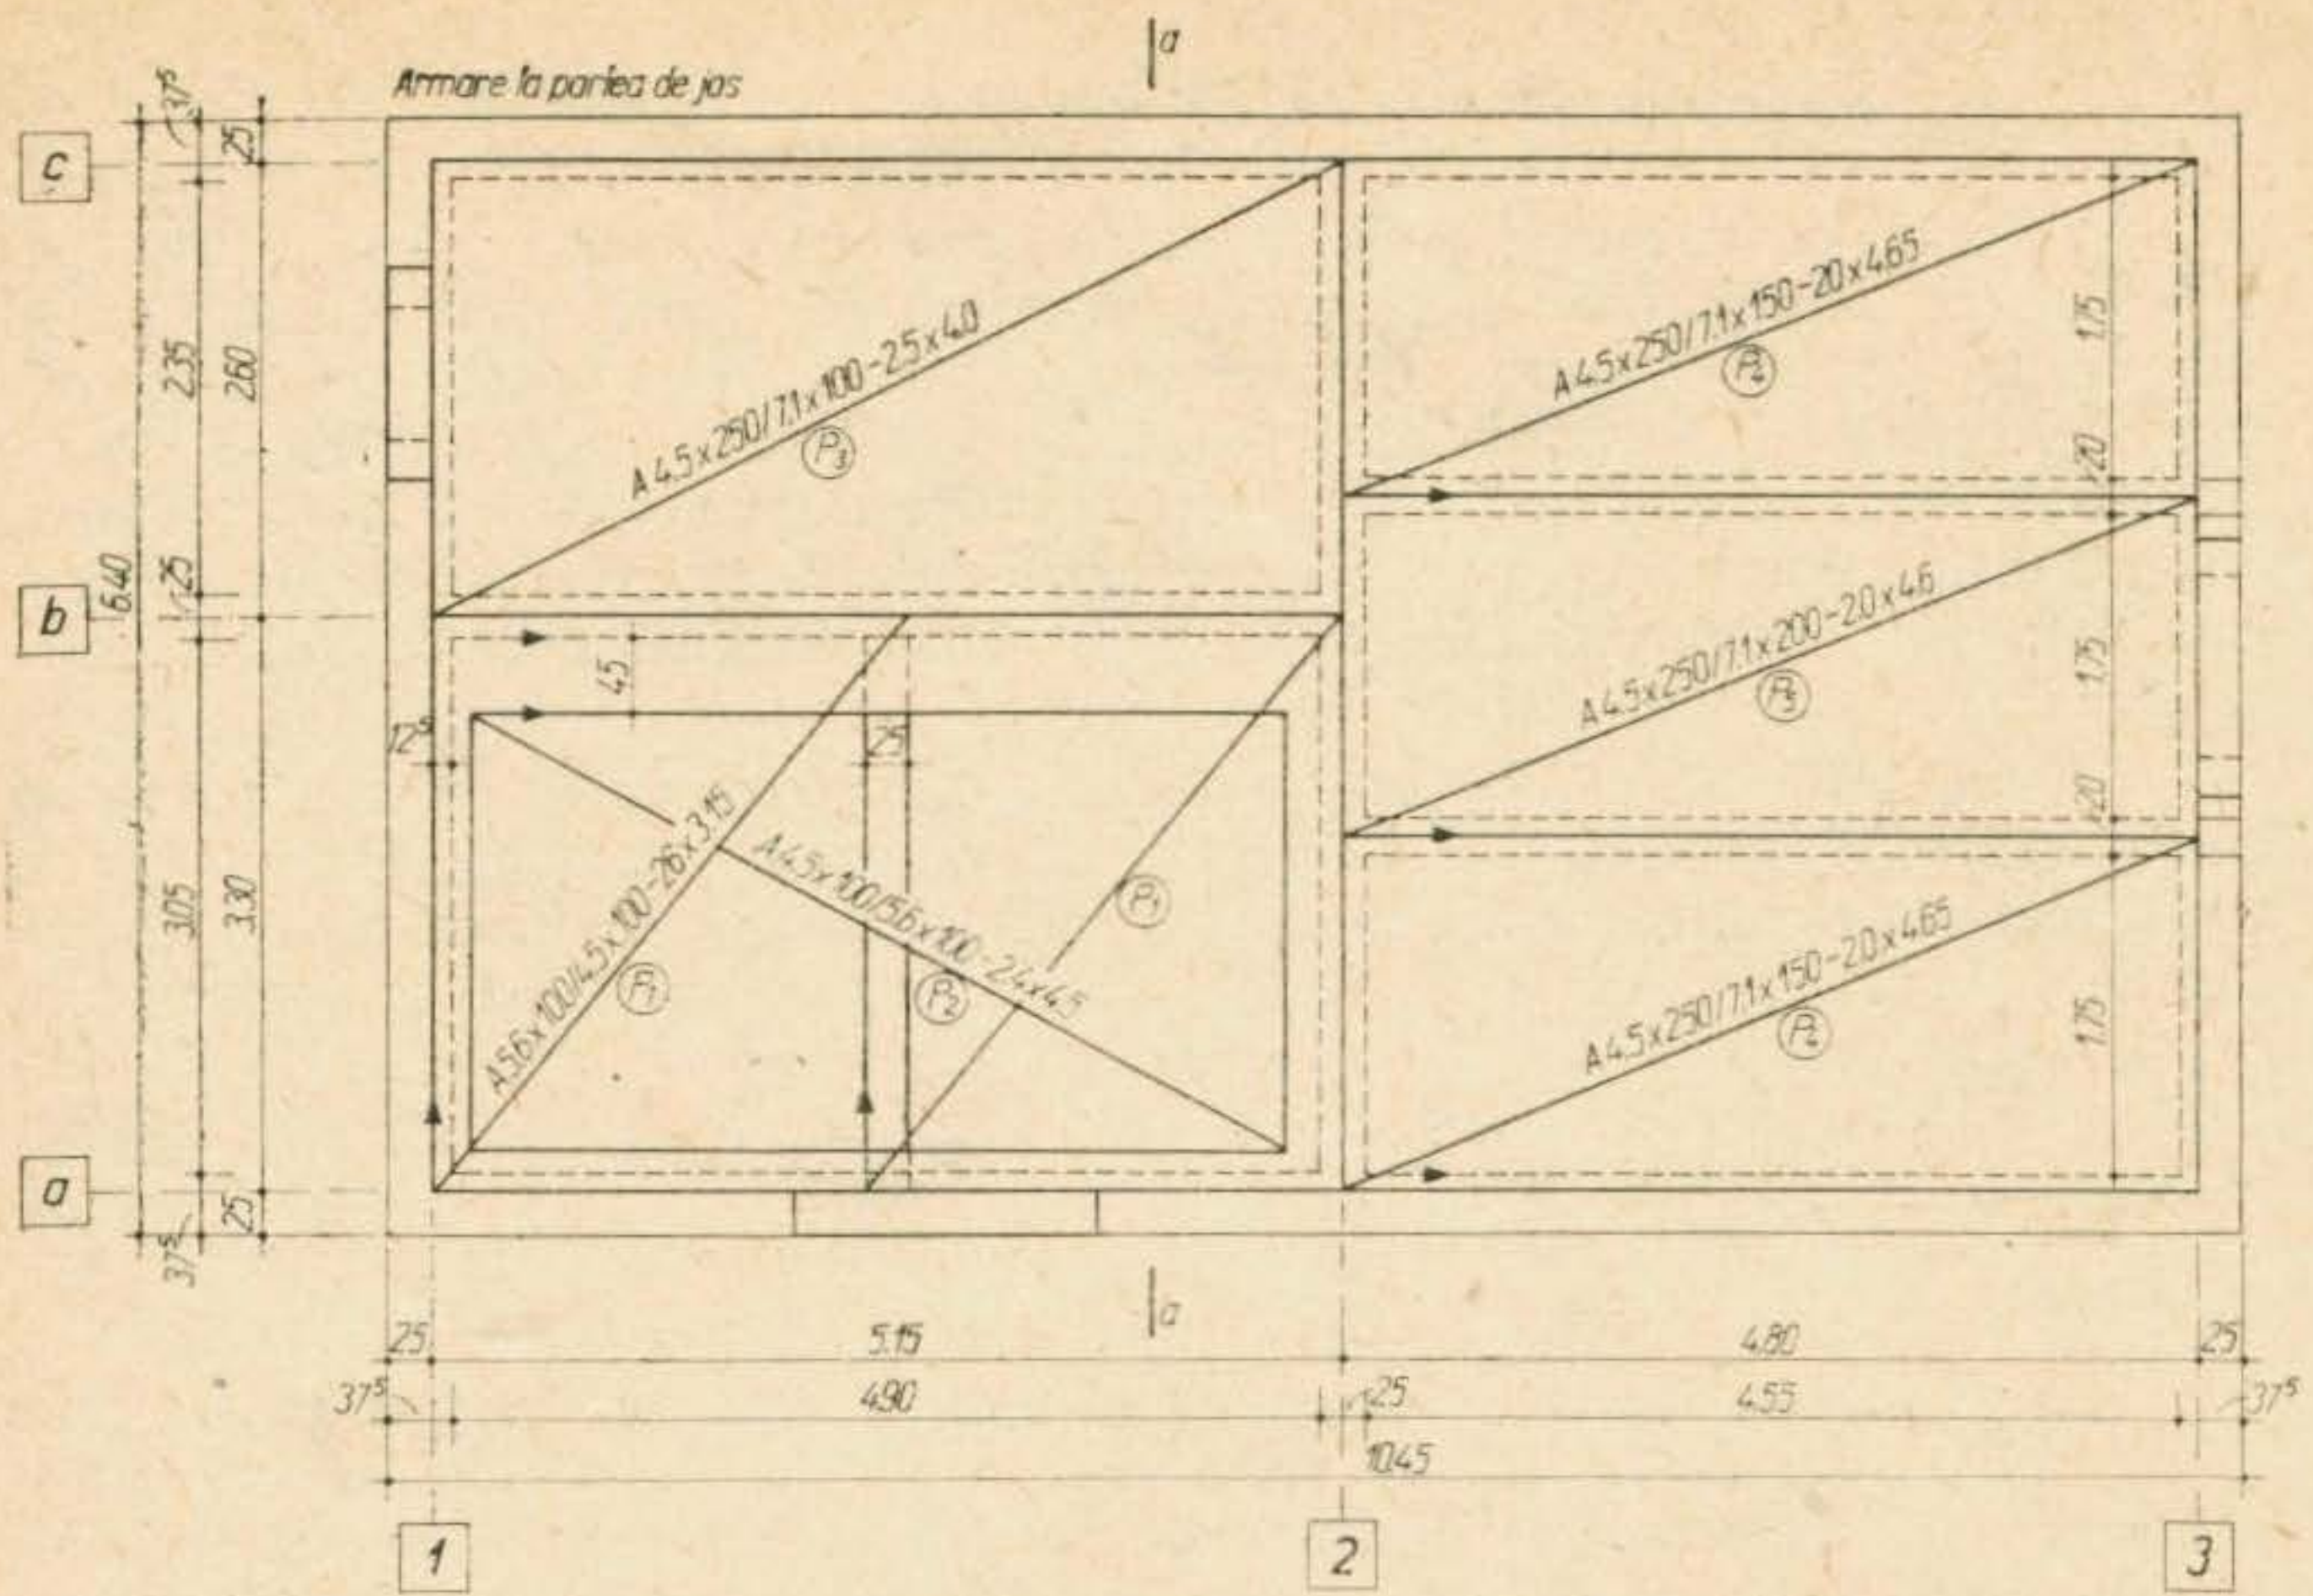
Plan nontaj plase sudate la un planșeu din beton armat monolit:
